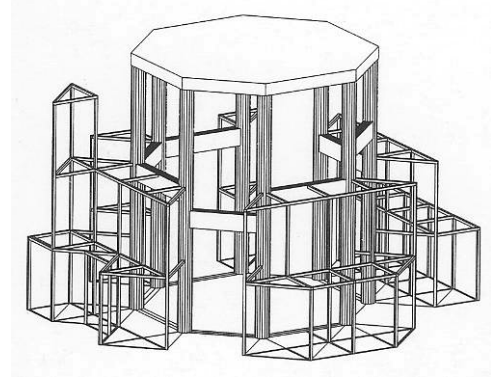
Giriş çadırının aksonometrik görünüşü [26,27,30]
